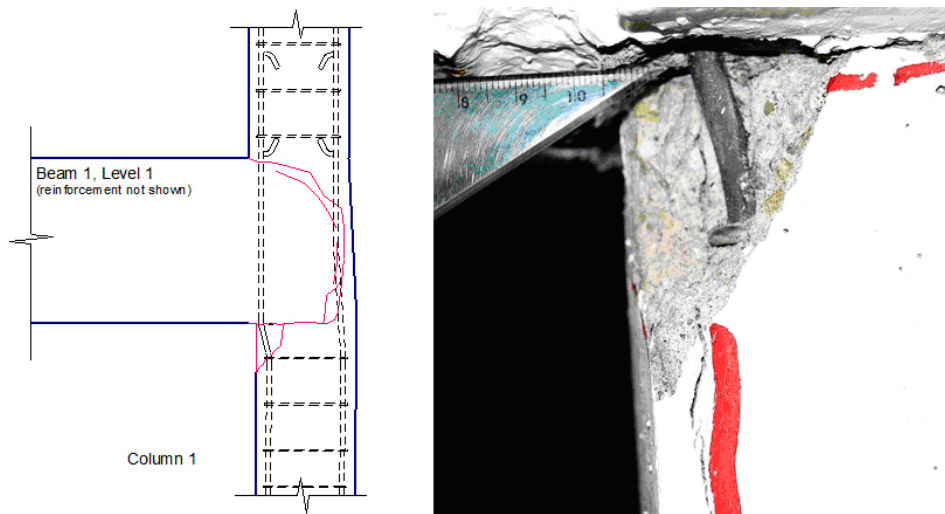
Falla de corte en columna de pórtico relleno de mampostería (Lanese et al 2009).
